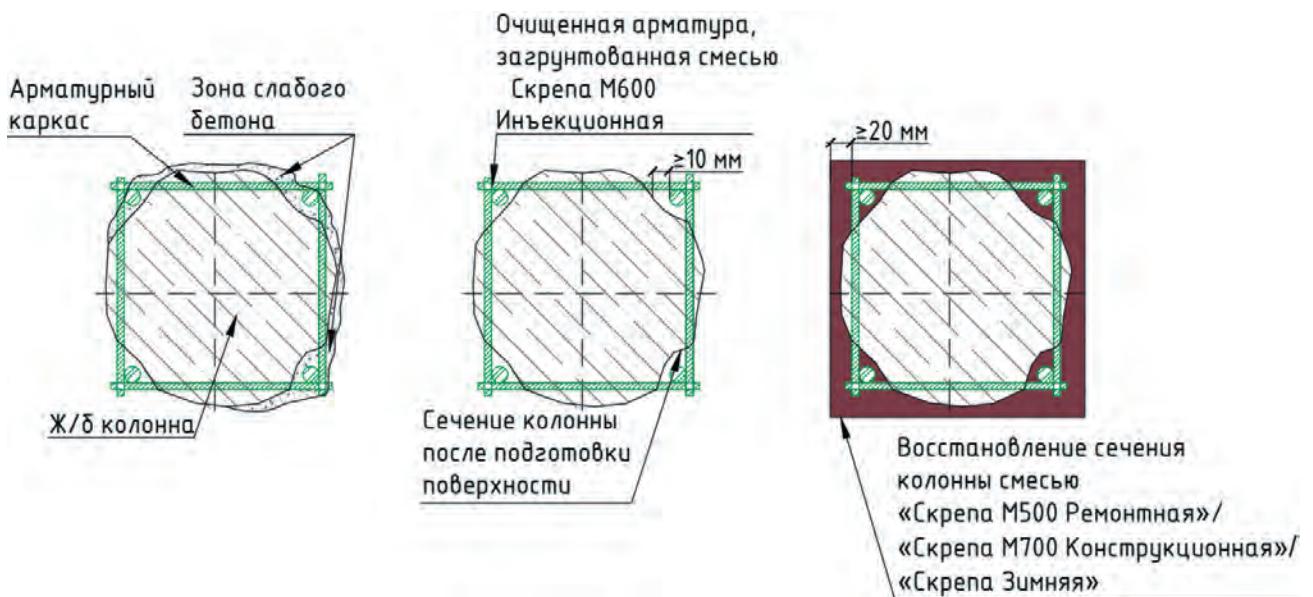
Схема восстановления железобетонных колонн
